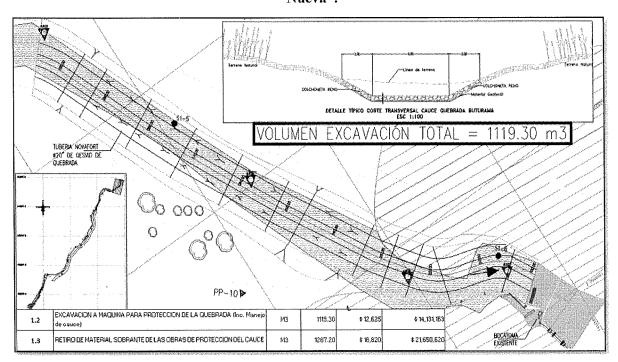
Plano HMC-122-PL-DIS-18A, y presupuesto final de la obra.
